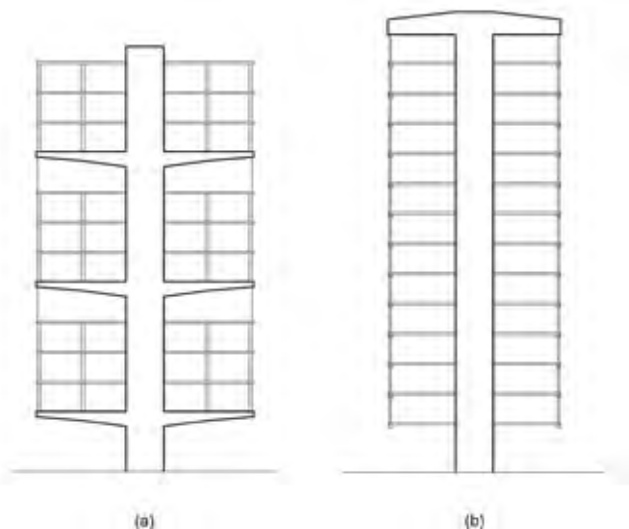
Edificio con núcleo central y (a) plantas apoyadas o (b) plantas colgadas
